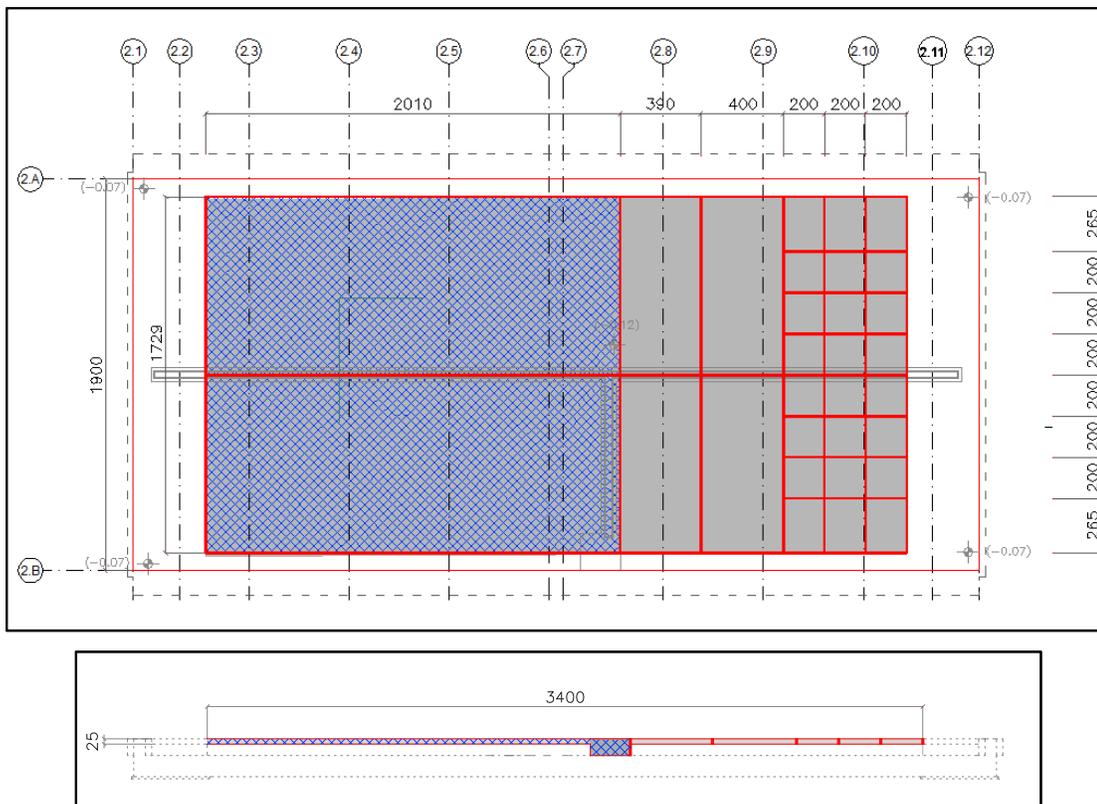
taglio e rimozione piastra di fondazione (Pianta e sezione)
